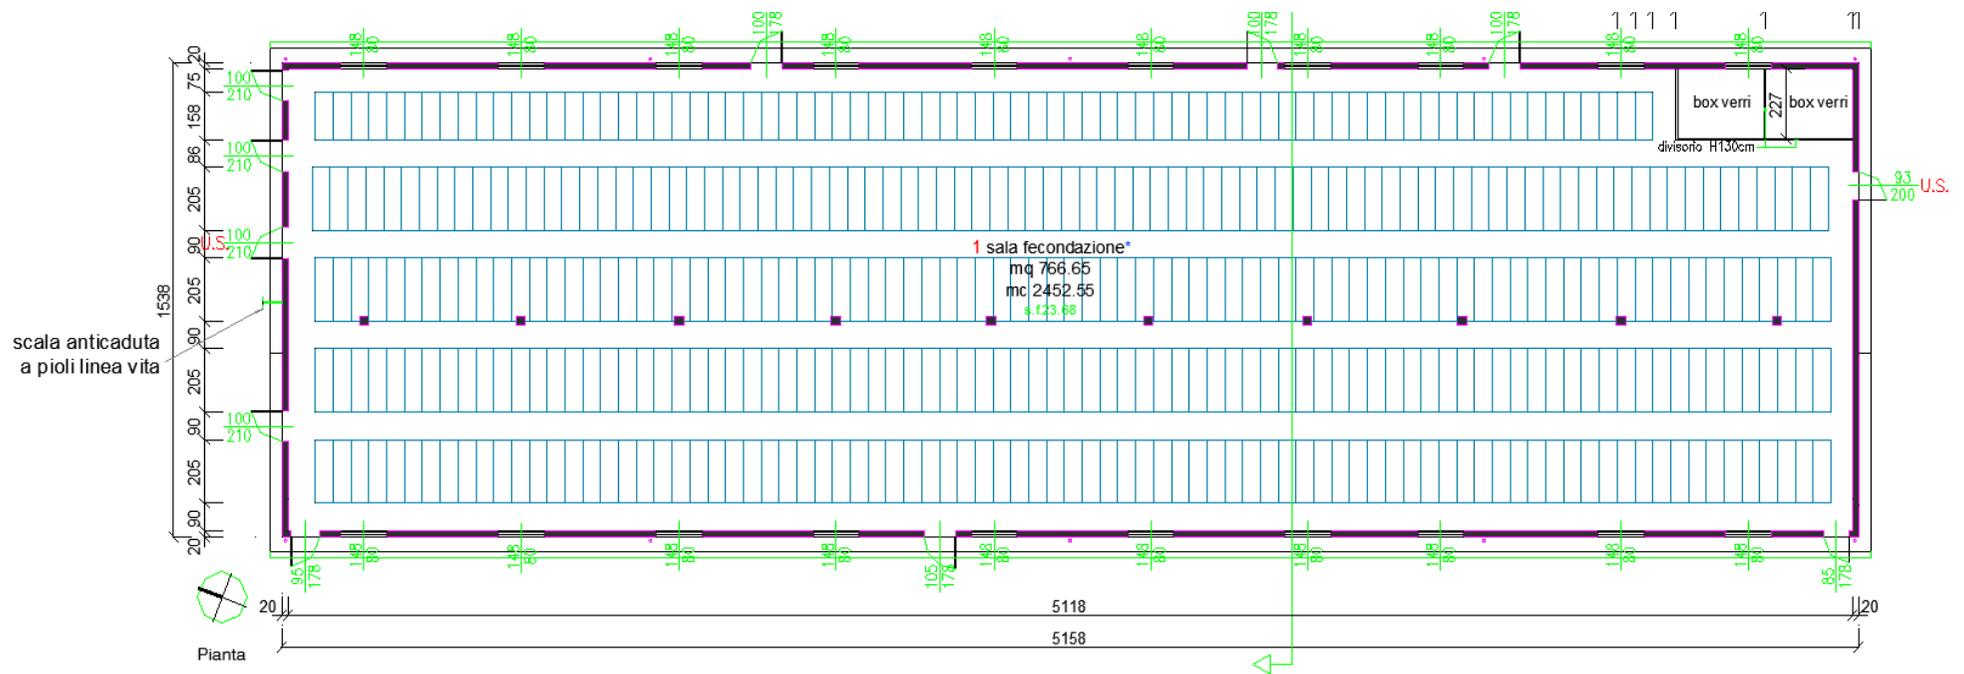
planimetria del capannone E3 (fonte: Arch. Bergamo)
